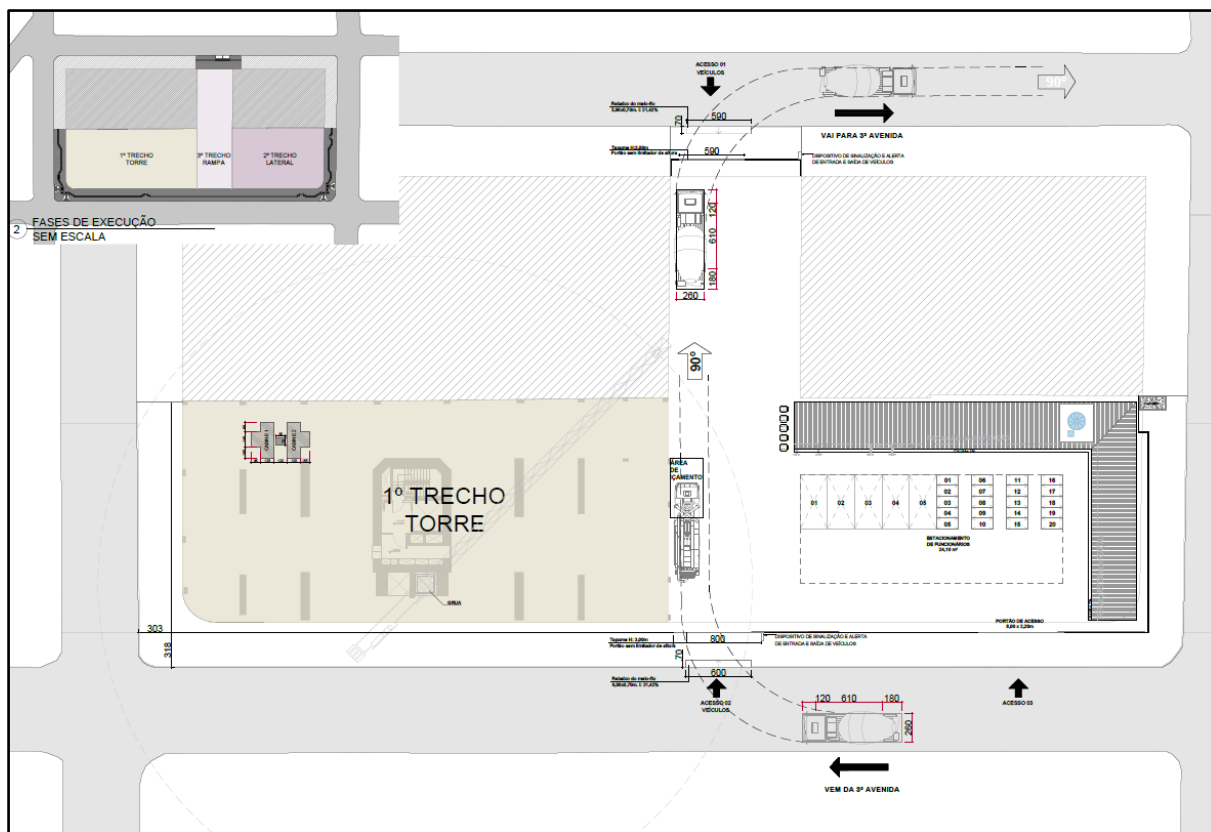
Implantação da primeira fase do canteiro de obras – Raio de Giro conforme AASHTO
